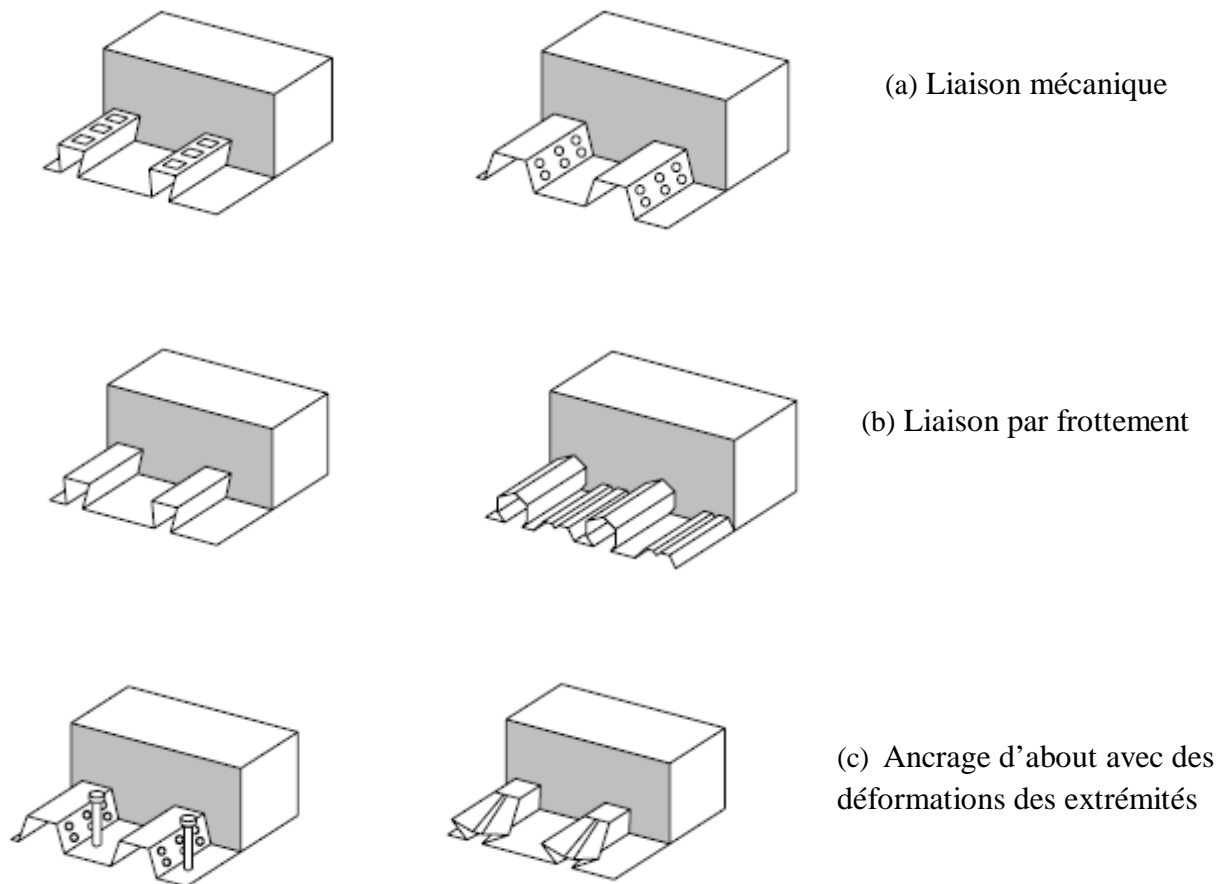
Exemples de dalles mixtes avec tôles profilées collaborantes.
